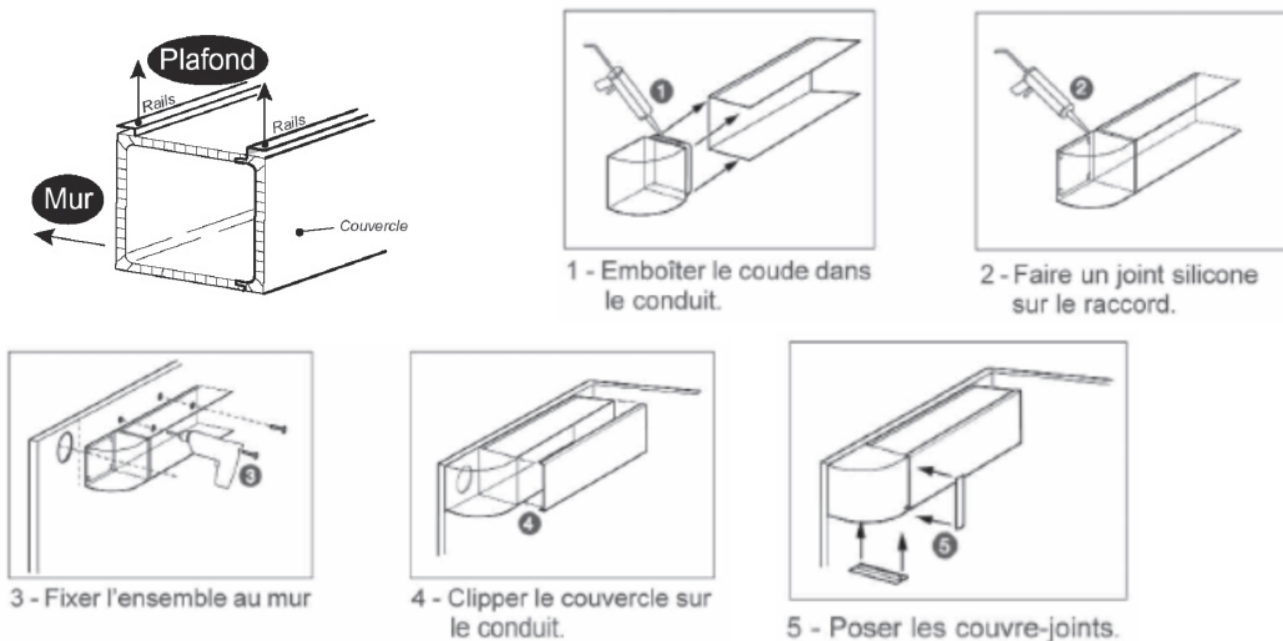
Exemples de mise en œuvre des conduits horizontaux T2a
